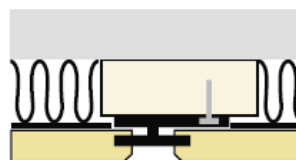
iiii. Detalles de montaje de los paneles acústicos Notsound. Fuente: www.notsound-acustica.com
